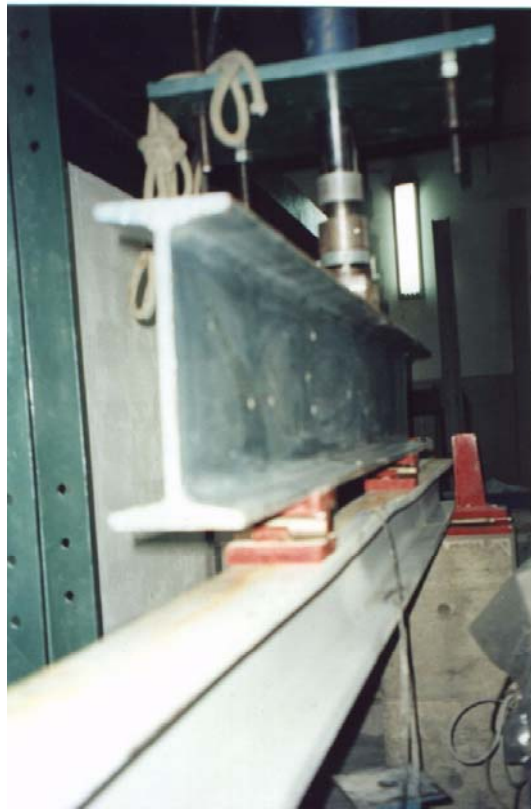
Detalhe do sistema de aplicação de cargas.
